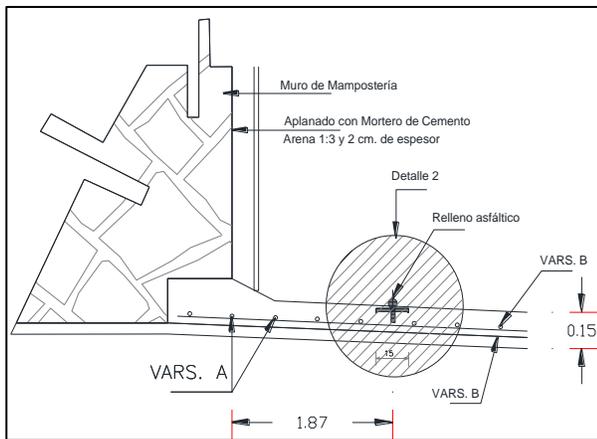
Detalle junta de polivinilo en tanques de mampostería.
